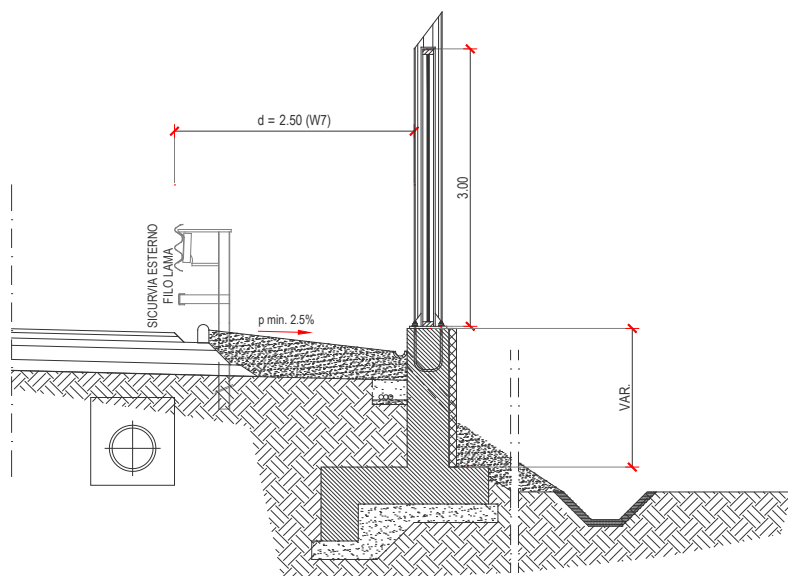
Sezione tipo di barriera con pannello trasparente in PMMA.
